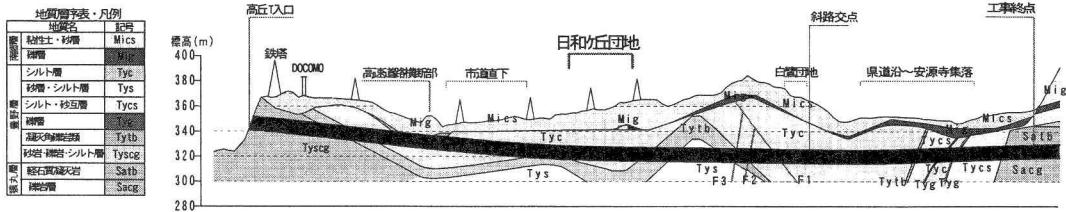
高丘トンネル南工区地質縦断面図及び保安物件位置図
